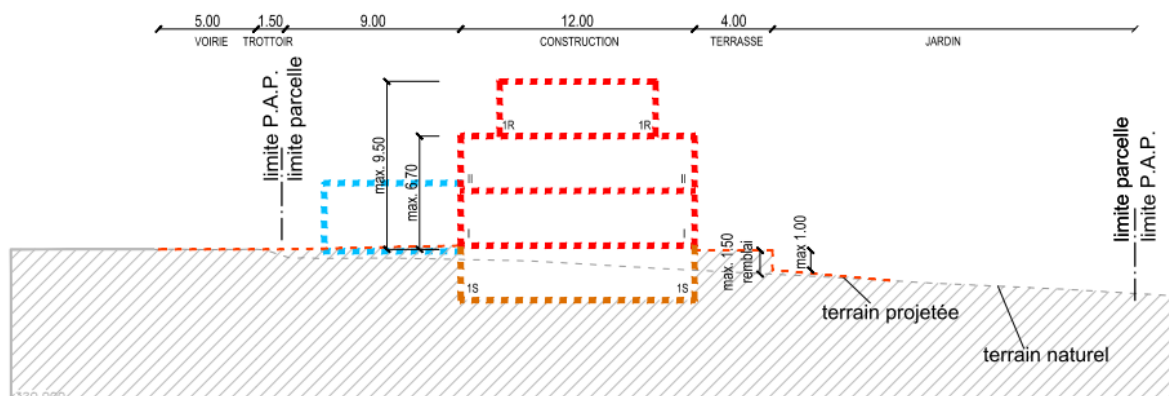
coupe illustrative du projet, plan non contractuel (Source : Best)
